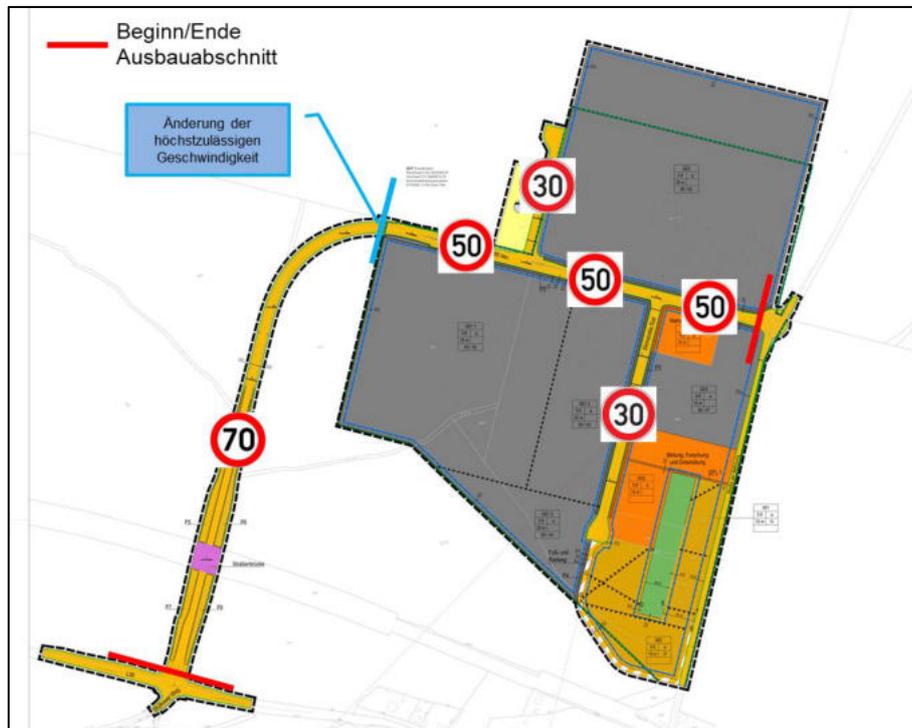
Planzeichnung Bebauungsplan 57 mit ergänzten höchstzulässigen Geschwindigkeiten.
